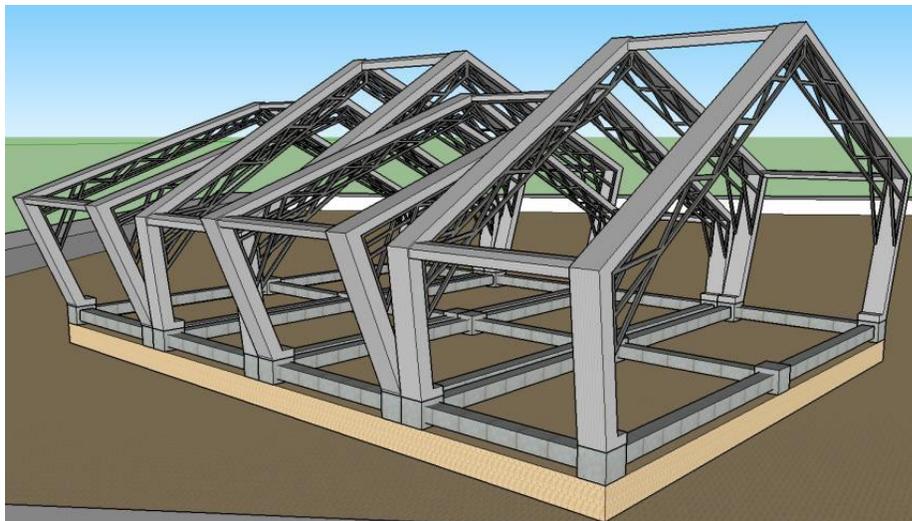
Detalle Constructivo Estructura metálica y cimentación Bloque A
